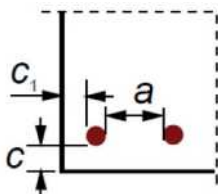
Значения для прямых стержней в балках и перекрытиях
